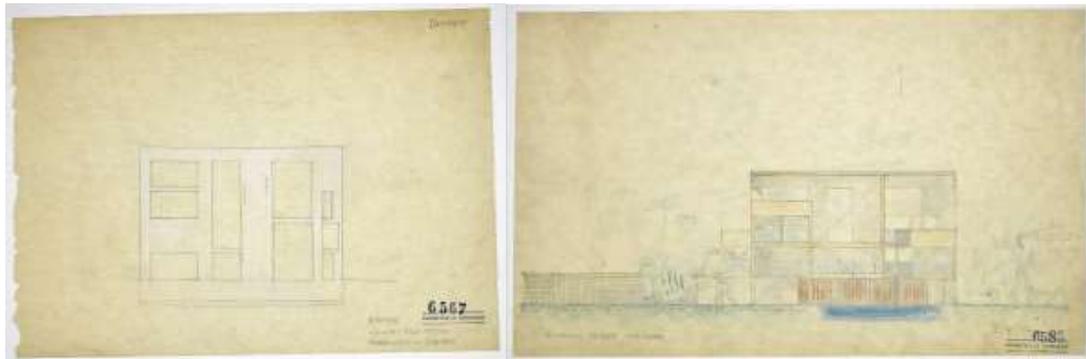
FLC 6567 coupe nord-ouest/sud-est et FLC 6585 façade sud-ouest
